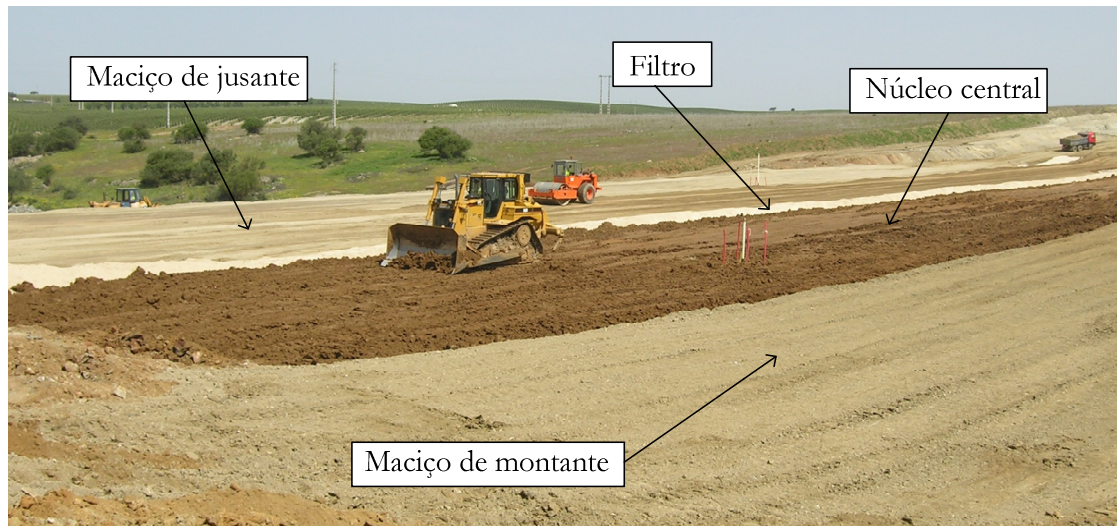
Vista do núcleo e maciços de montante e jusante da barragem durante a construção.
